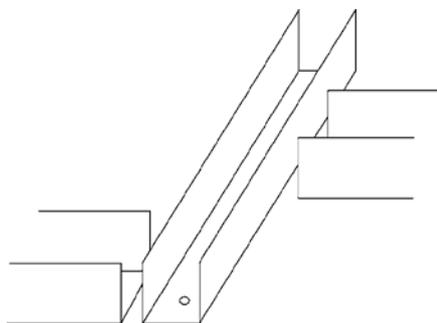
Pose des rails bas : interruption au droit des raccords d'angle ou en T
